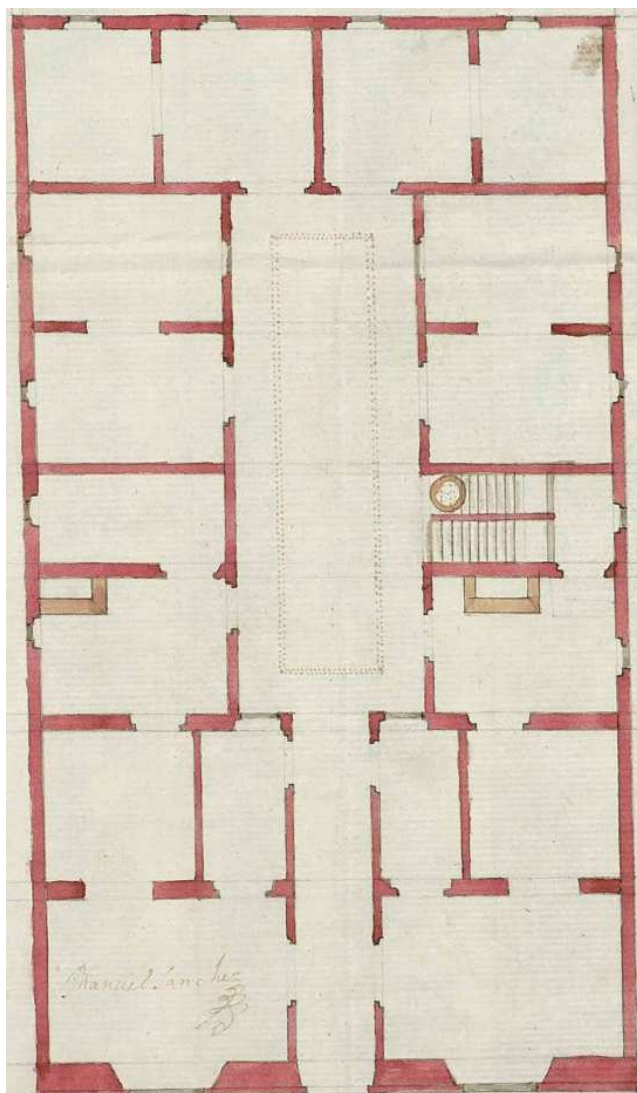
Planta construida en c/ de la Greda (1748-AVM:1-84-106).
